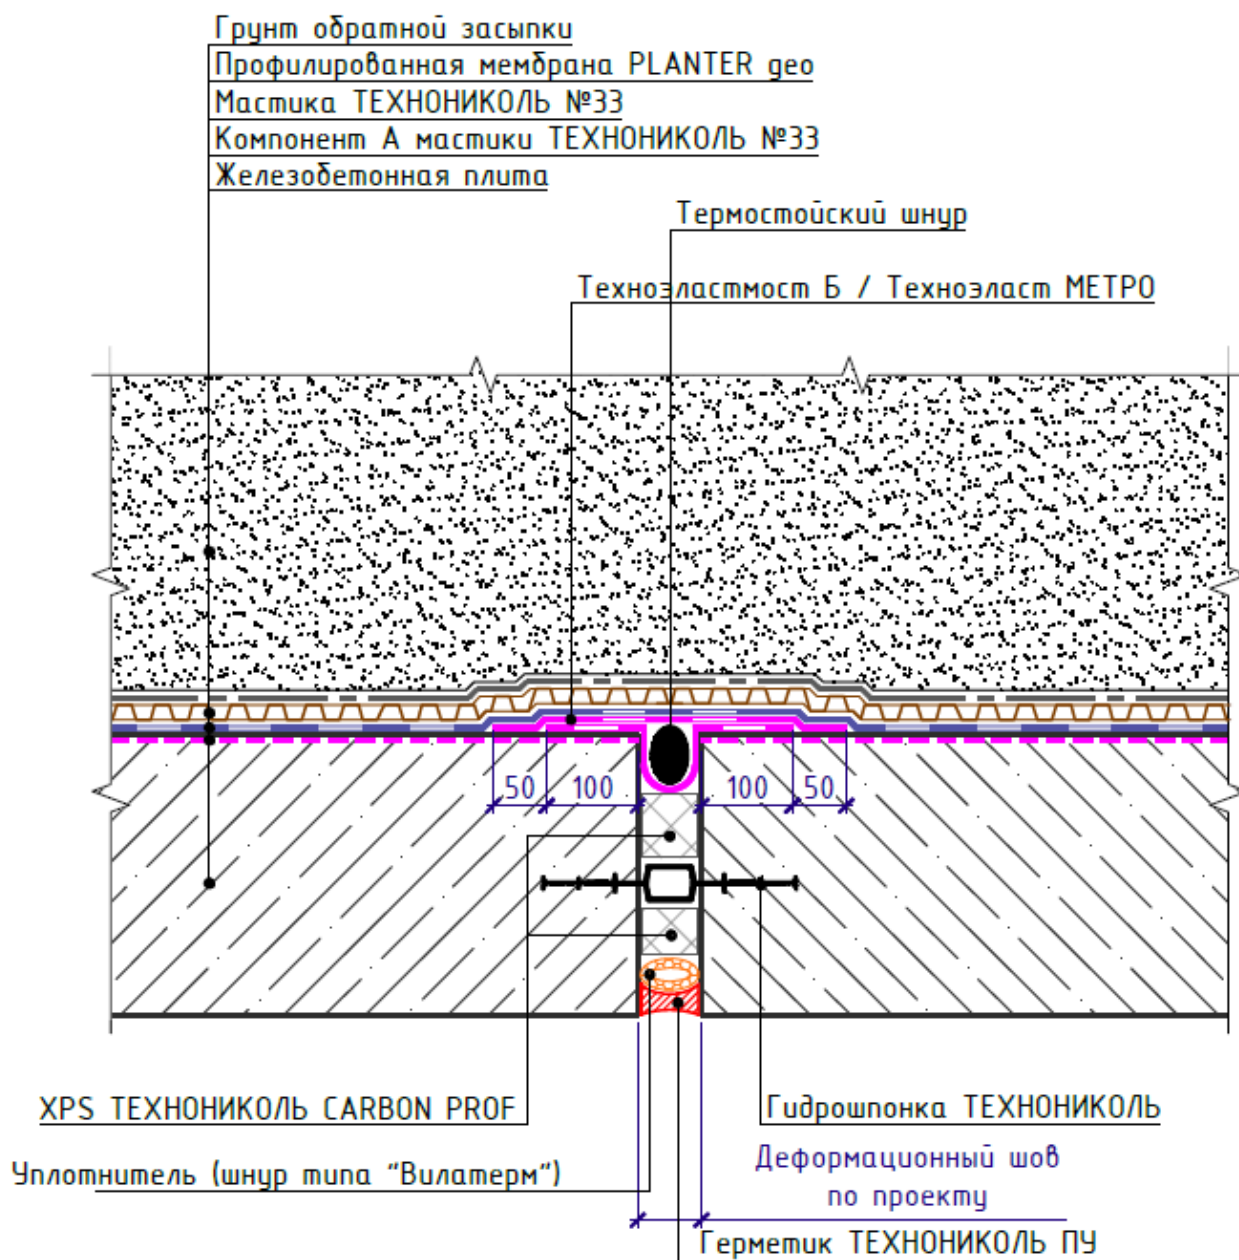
Гидроизоляция деформационного шва в перекрытии
